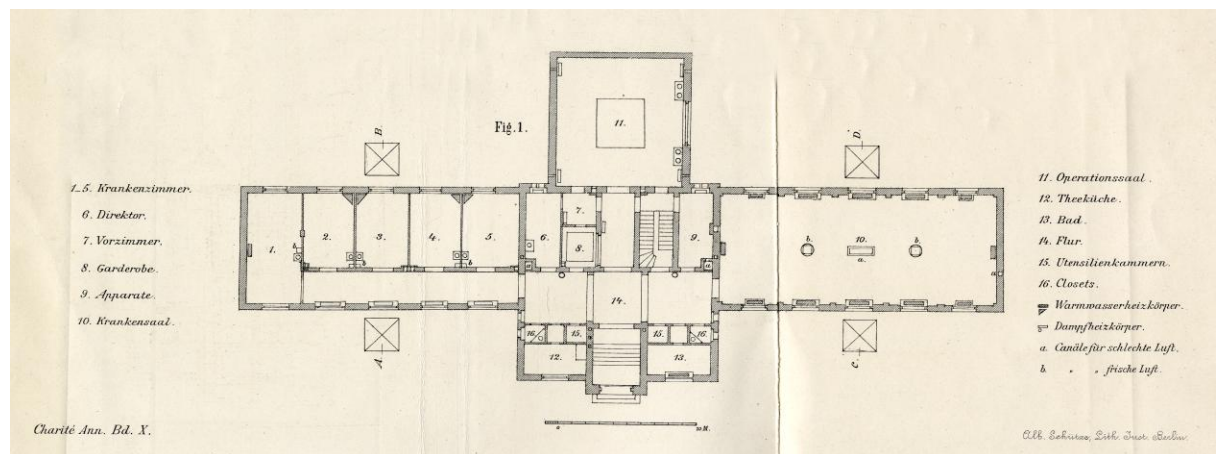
Grundriss des gynäkologischen Pavillons (Mehlhausen 1885 Tafel I)
